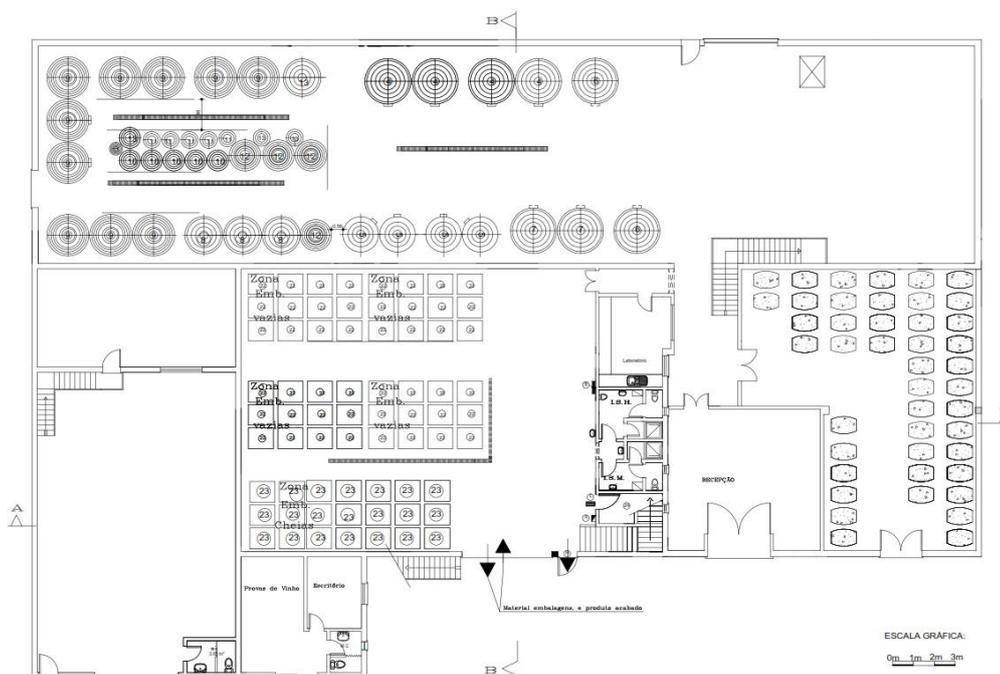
Adega Quinta da Vinha – Planta do Piso 0⁵⁴
